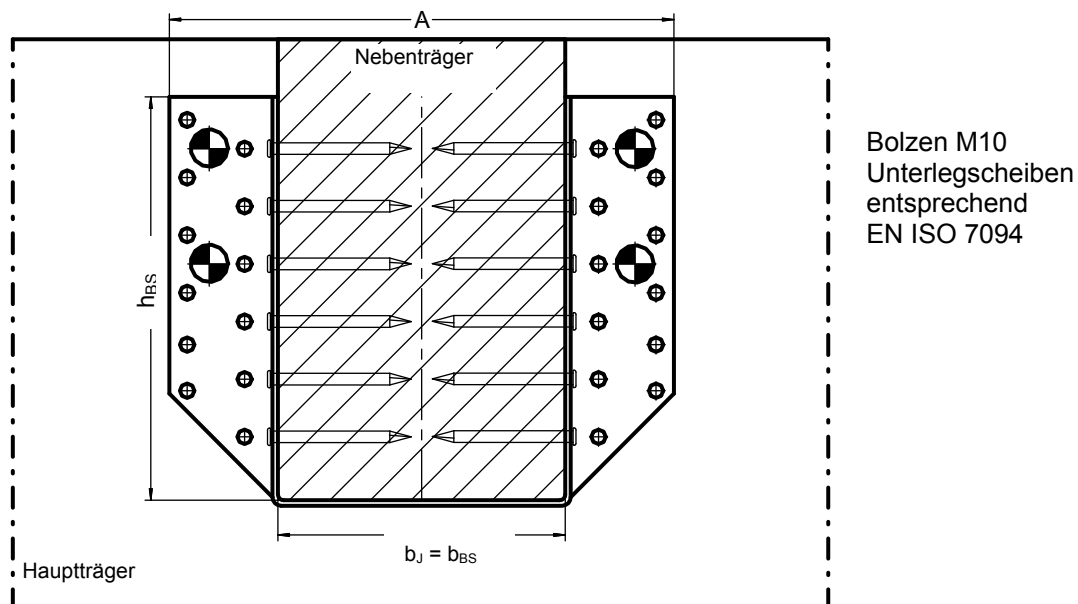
BB Balkenschuhe in Holz/Beton, Holz/Leichtbeton oder Holz/Stahl Verbindung mit Bolzen
